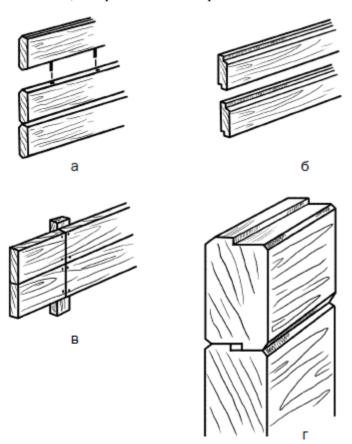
Способы соединения стеновых элементов: а – с помощью нагелей; б – выбранной четвертью; в – сплачивание на стойках каркаса; г – фальцами
